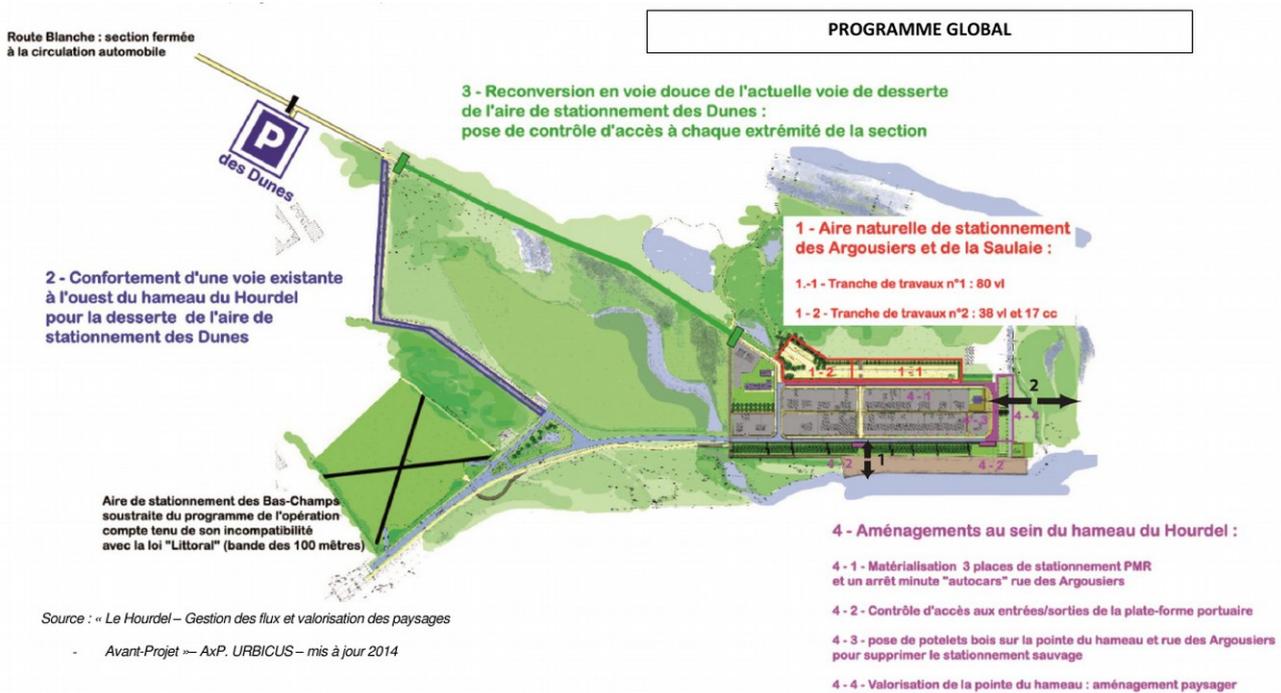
plan des opérations prévues sur le site (Source dossier)
